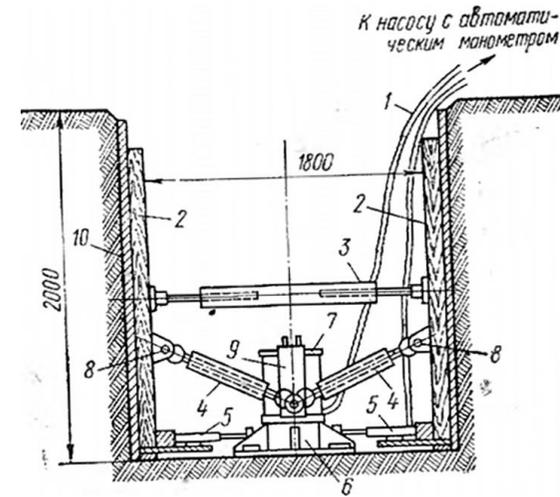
Схема установки НИИОСП (конструкции И. Н. Круглова) для испытания пород пробными нагрузками в шурфах:
